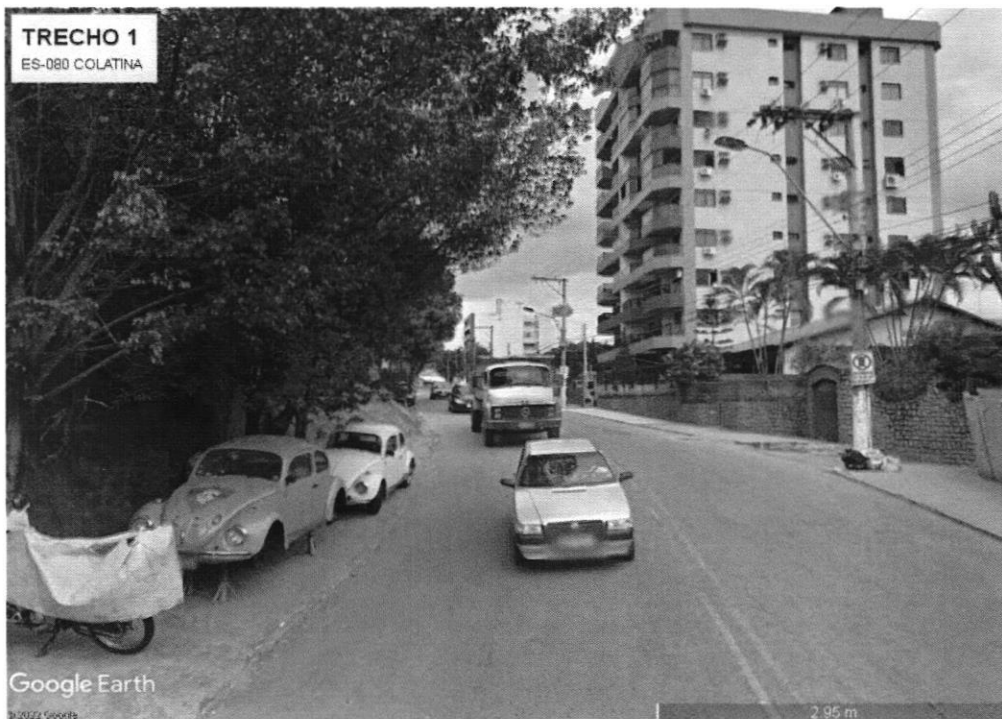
FOTO MOSTRANDO CONSTRUÇÕES, ILUMINAÇÃO PÚBLICA E CALÇADAS
